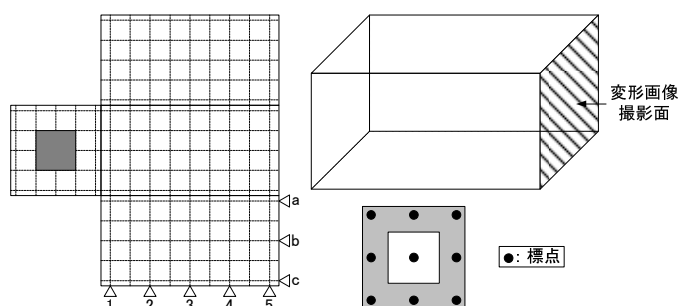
ひび割れ測定方法およびゲージ貼付位置
